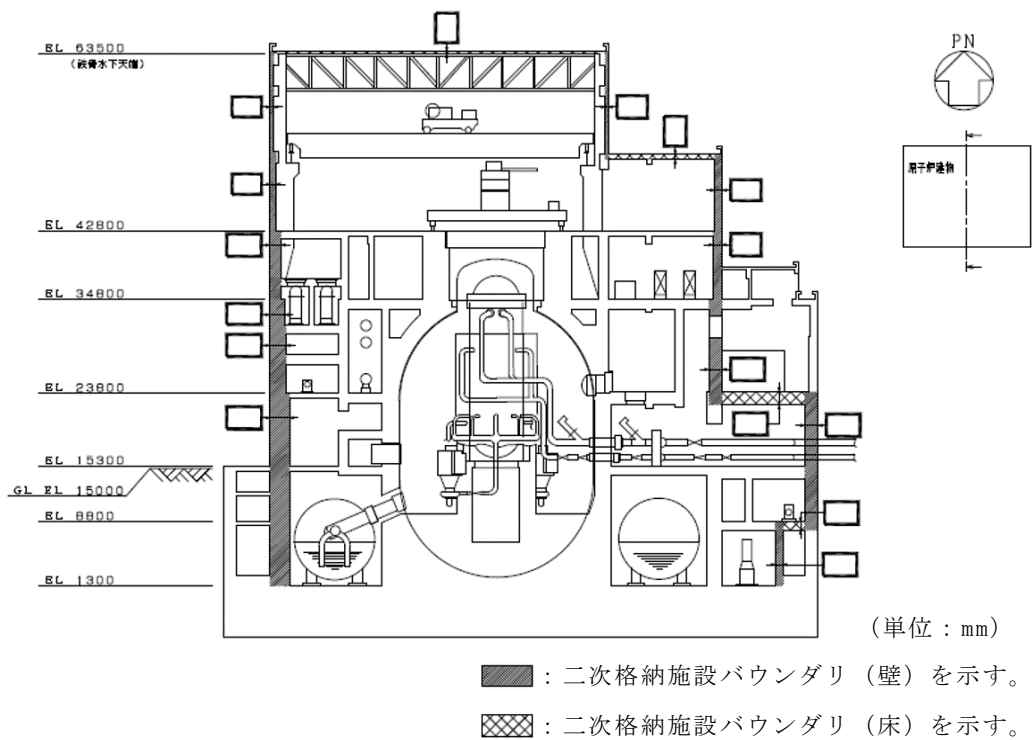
(1) 原子炉建物原子炉棟（二次格納施設）の範囲の断面図（N S方向）
